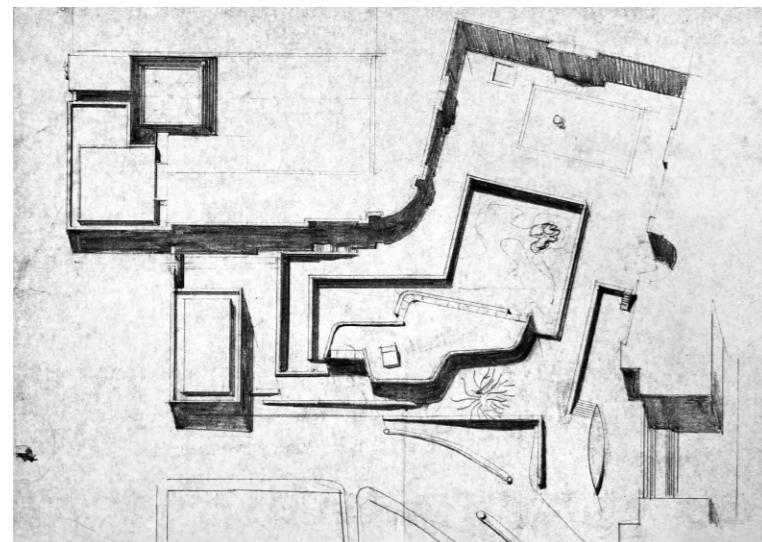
Plan de toiture, 7^{ème} esquisse.
